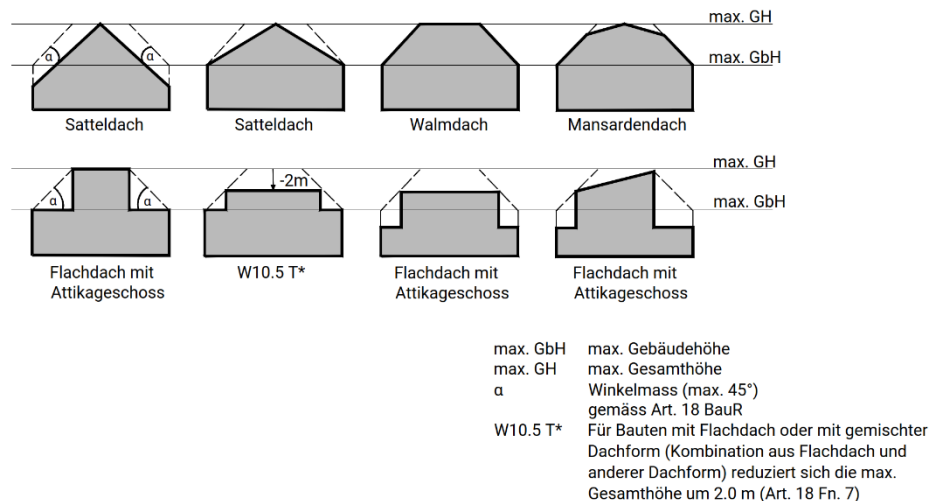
Mögliche Dachvarianten innerhalb des Dachraums
